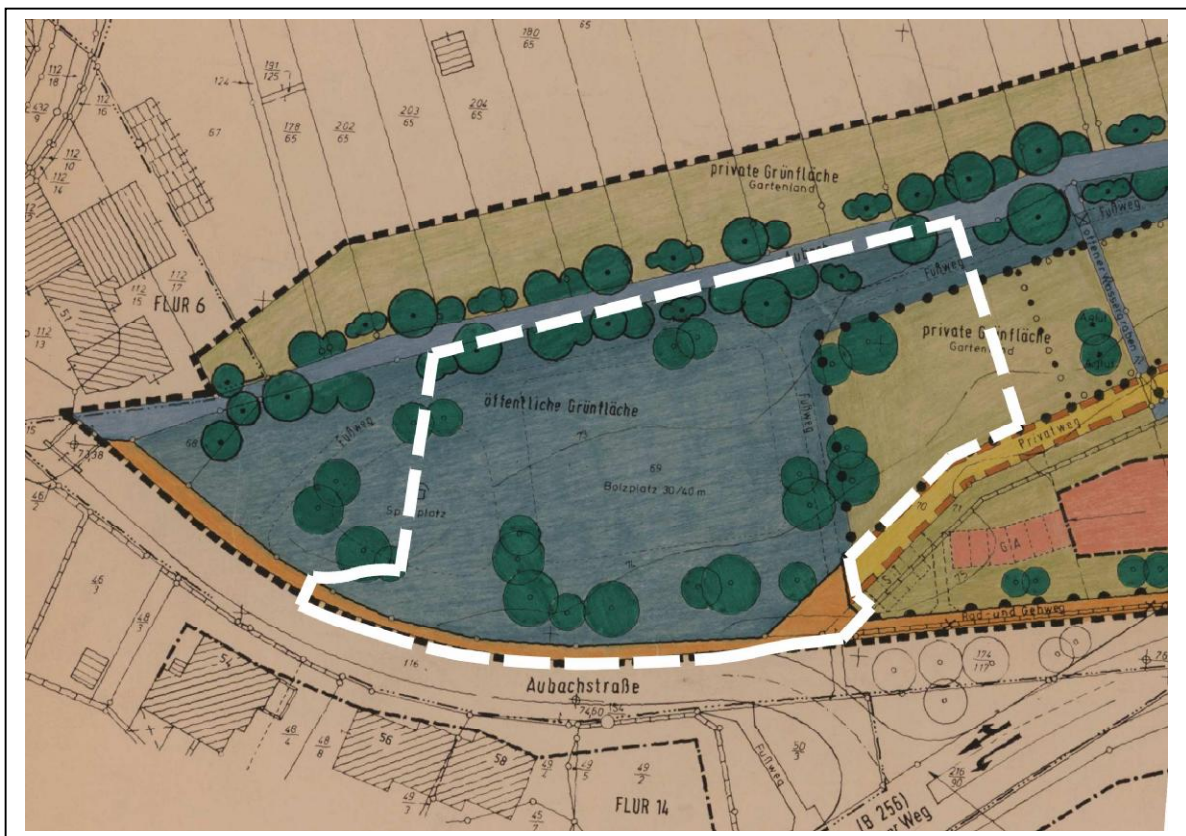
Bestehendes Planrecht – Rechtskräftiger Bebauungsplan 936 II „Bereich zwischen Aubachstraße und Aubach“ mit Geltungsbereich der vorgesehenen 1. Änderung - unmaßstäblich
